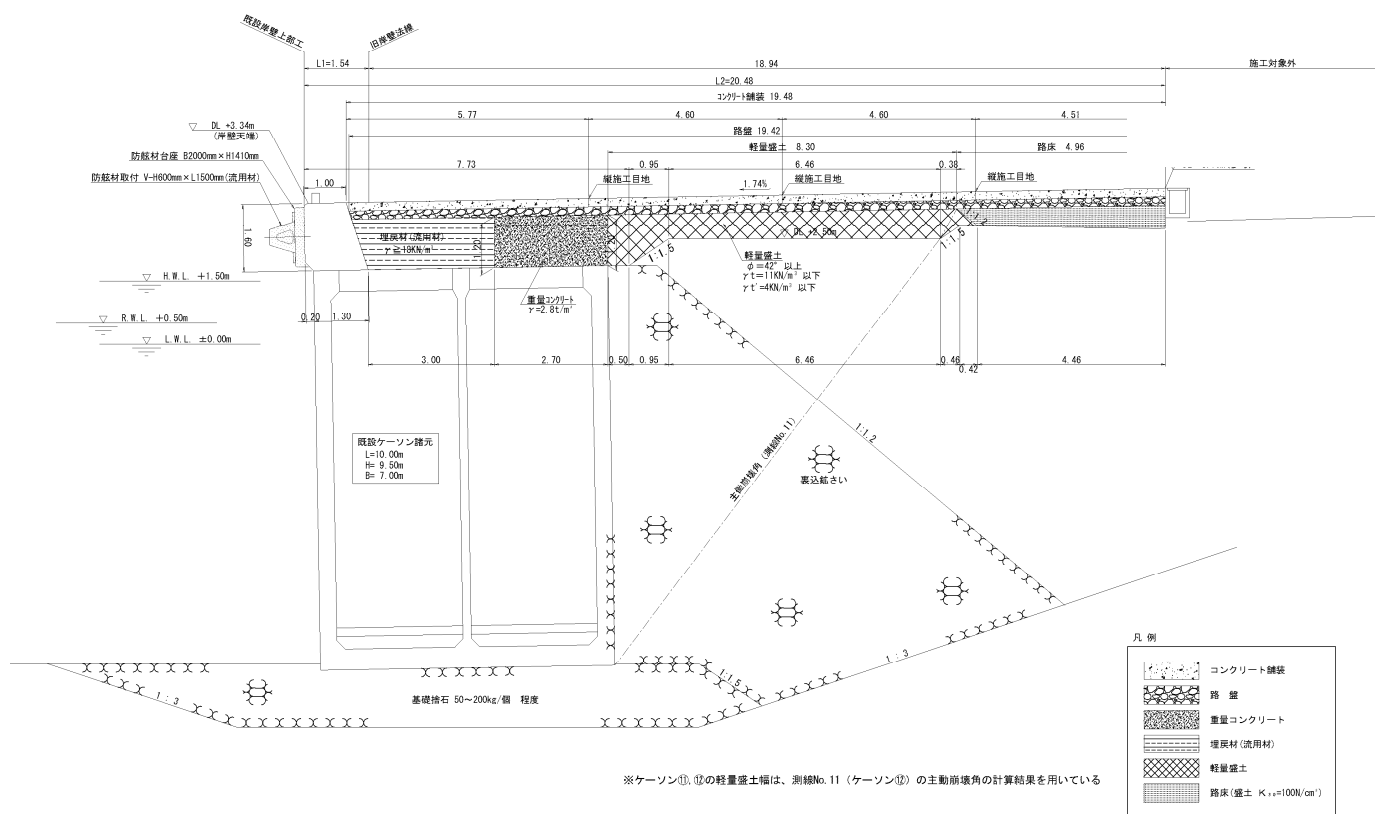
No. 2 南公共ふ頭D岸壁(-7.5m)断面図(復旧後) D-D
